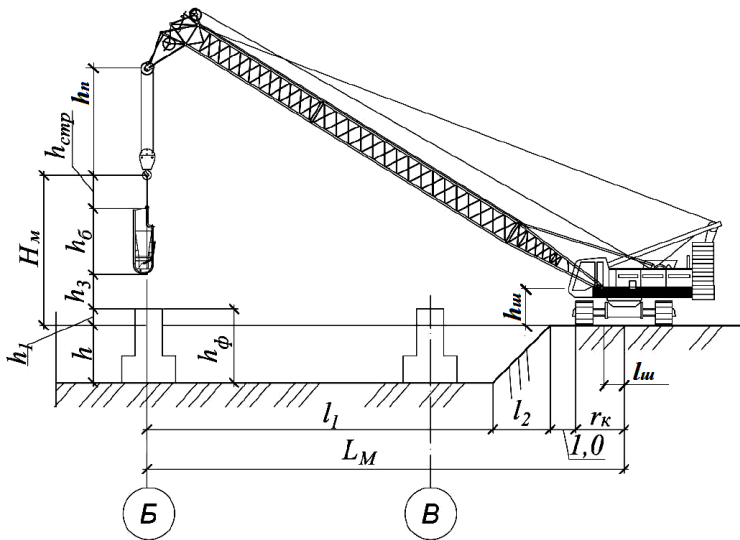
Схема для визначення монтажних характеристик будівельних конструкцій фундаментів.
